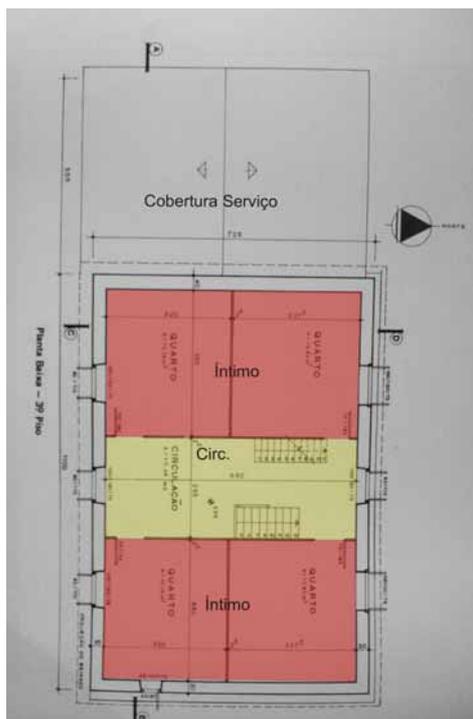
Planta baixa setorizada: segundo pavimento da casa rural da Colônia italiana Garibaldi (Imagem editada pela autora)
